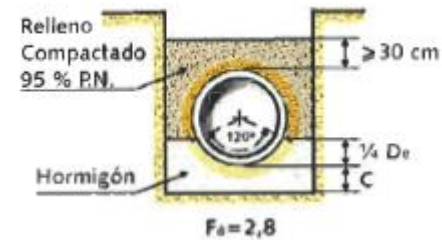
Factor de apoyo F_a para instalación en zanja
